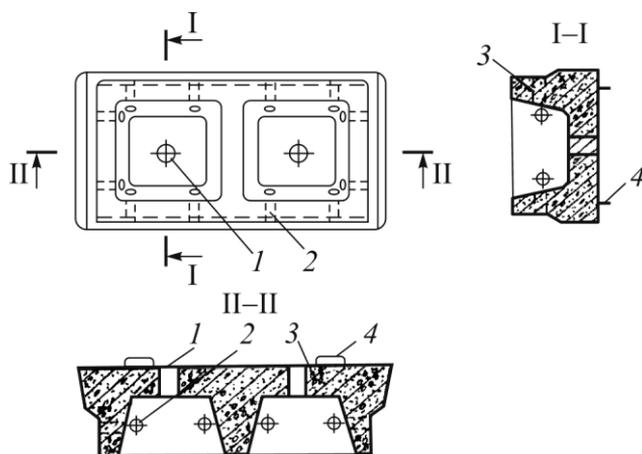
Конструкция тьюбинга: 1 – отверстие для нагнетания тампожа; 2 – отверстие для стяжных болтов; 3 – паз для чеканки; 4 – монтажные скобы
